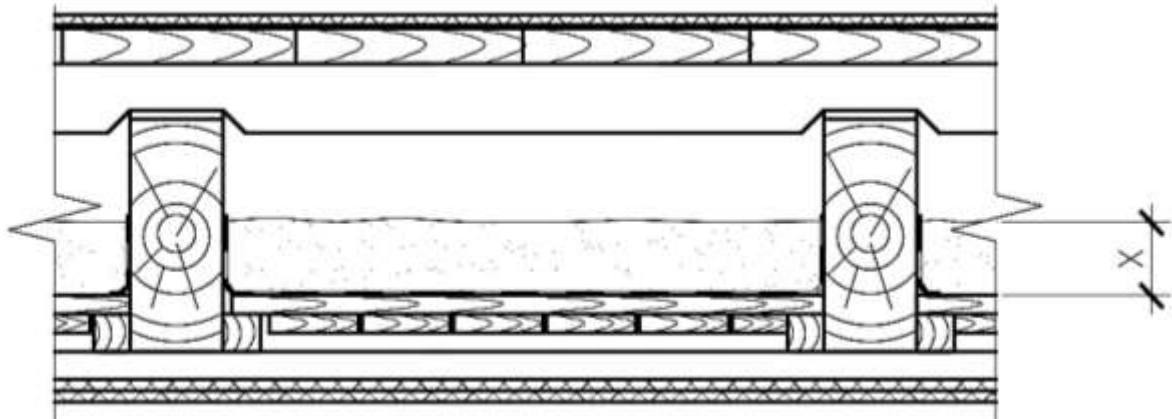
Схема міжповерхового перекриття на дерев'яних балках
